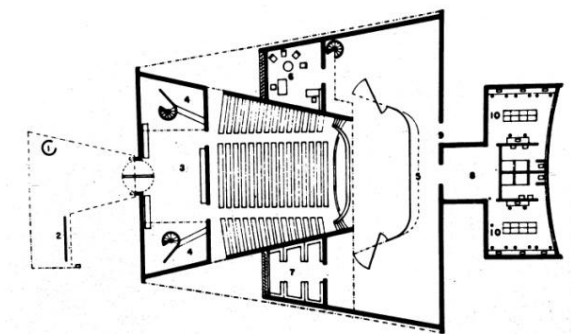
Planta baixa do Teatro Popular, planta baixa, Rio de Janeiro/RJ. Projetado por Affonso Reidy. Fonte: Bruand (2010:234).
